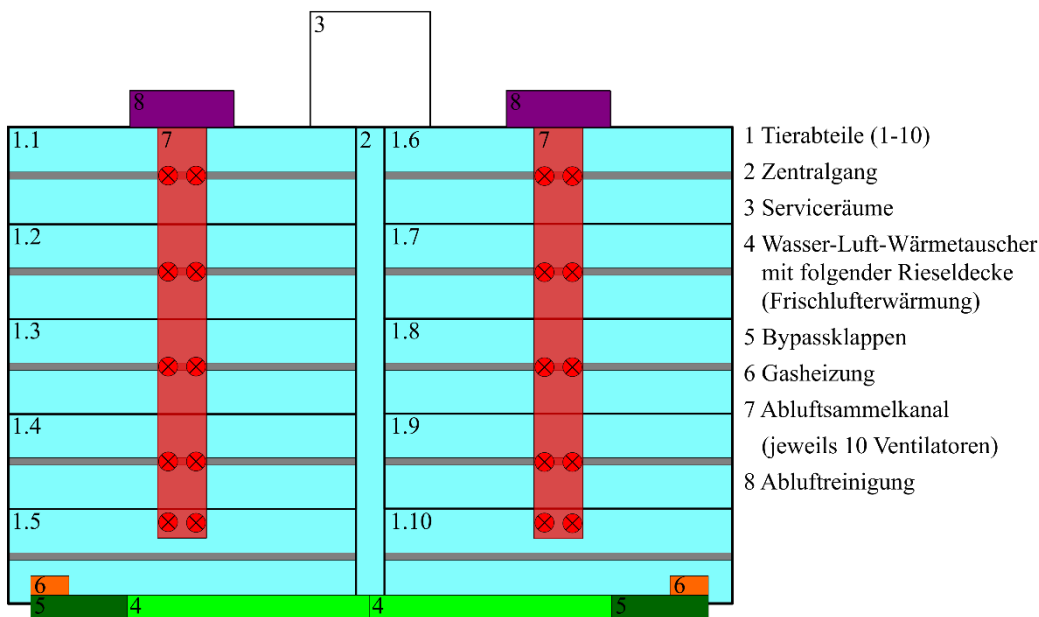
Schematische Darstellung des Grundrisses des Stallgebäudes auf dem Betrieb 1 (nicht maßstabsgetreu). ©Deeken
